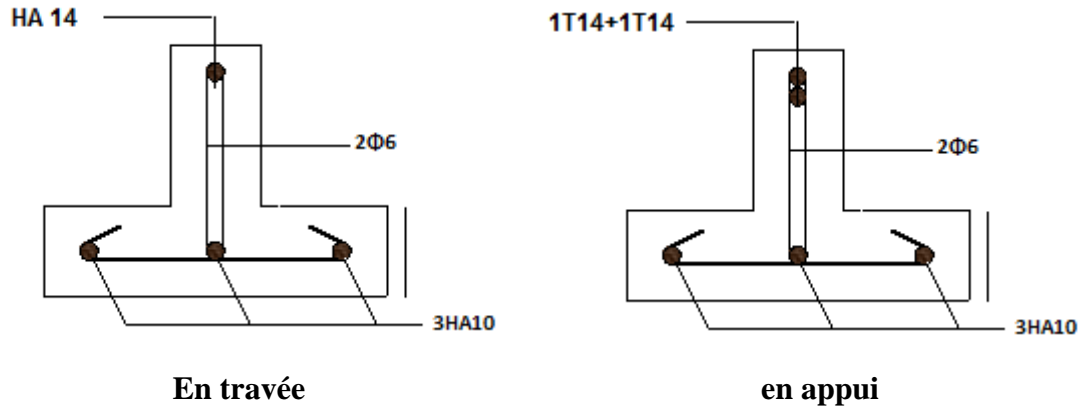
disposition des armatures dans la poutrelle type 2 (appuis et travée)
